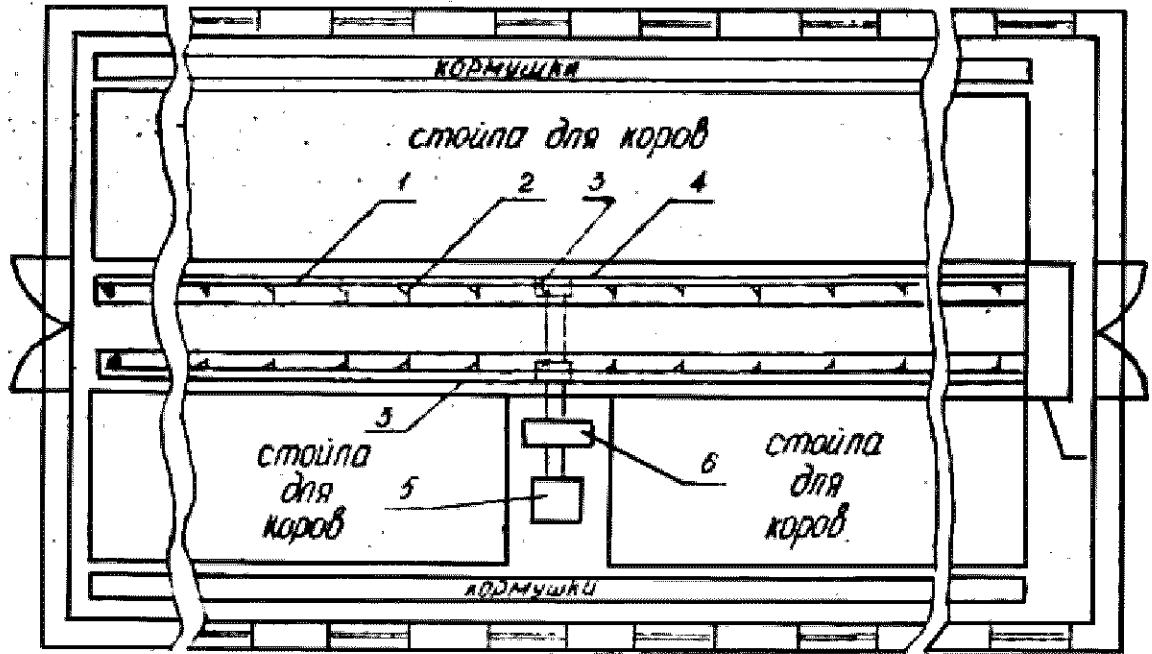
Схема расположения в двухрядном коровнике штангового навозоуборочного транспортера:
